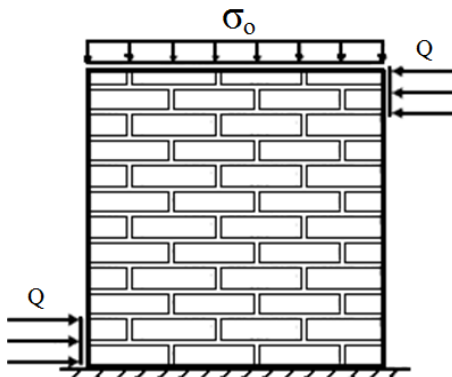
Схема нагружения стены при работе на срез по перевязанным сечениям
